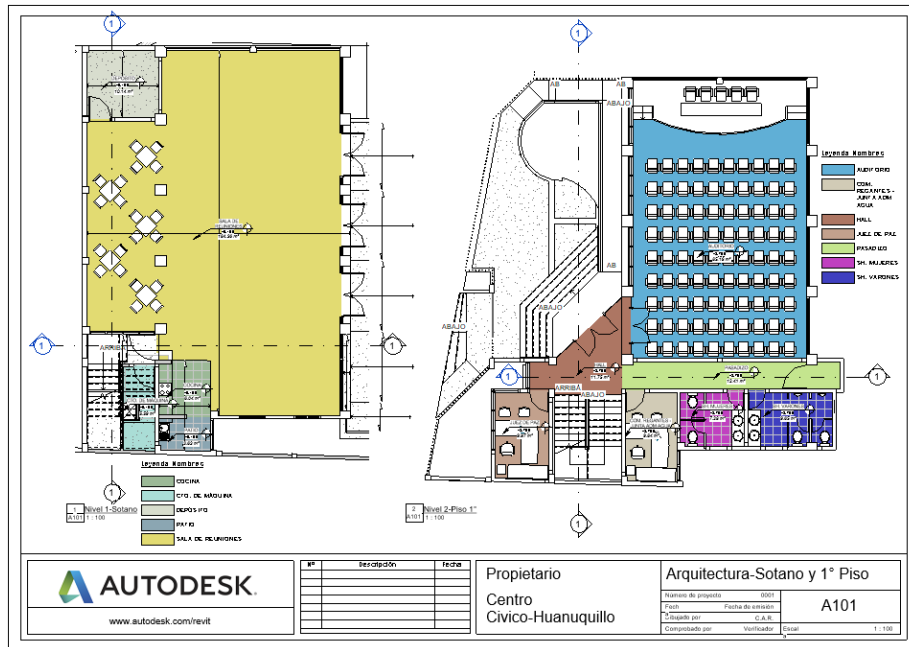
Plano de planta sótano y primer piso. Fuente: Autor
